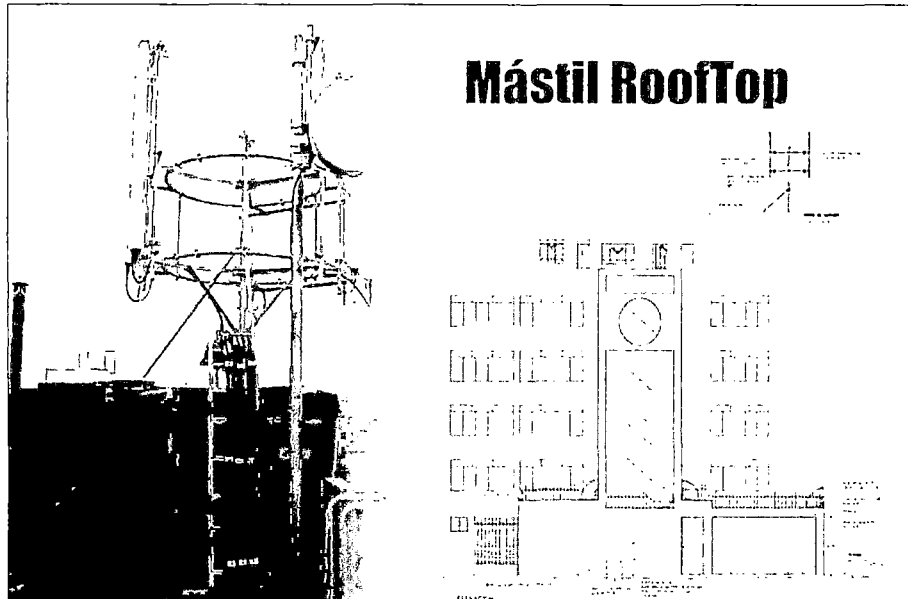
Mástil Rooftop instalado sobre un edificio.
